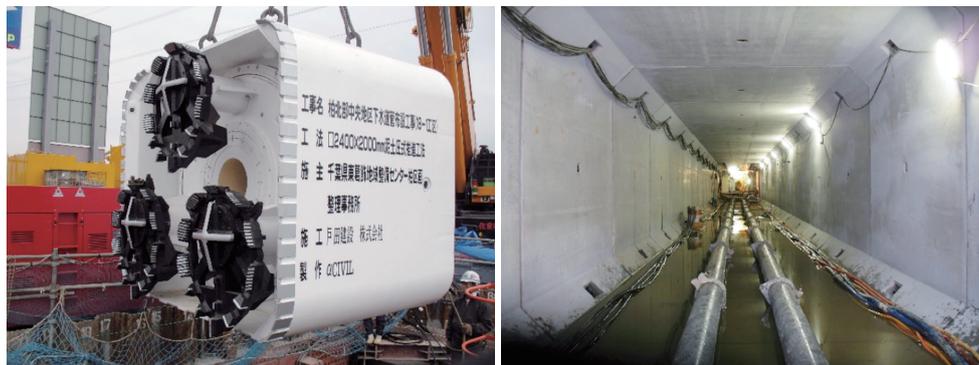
密閉型ボックスカルバート推進工事：平成19年施工
